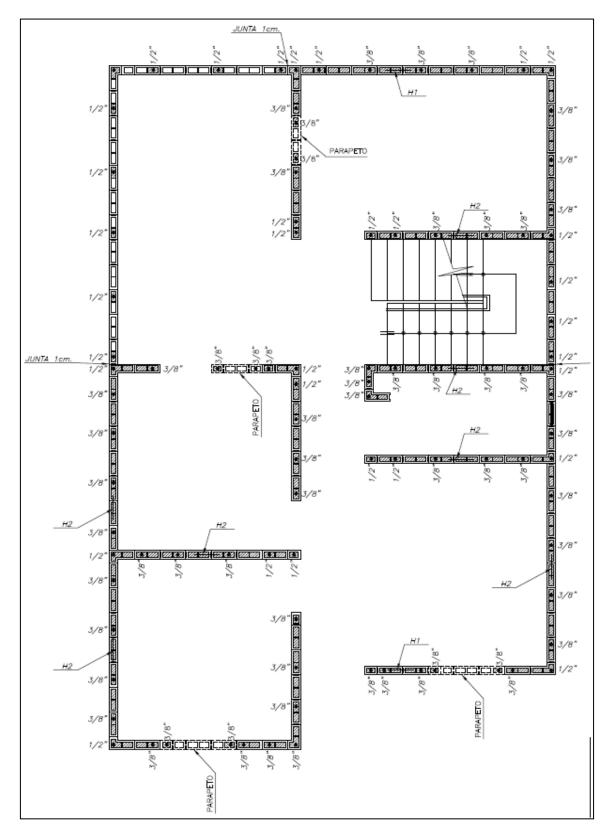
Plano de refuerzo de muros – Primer Nivel.
